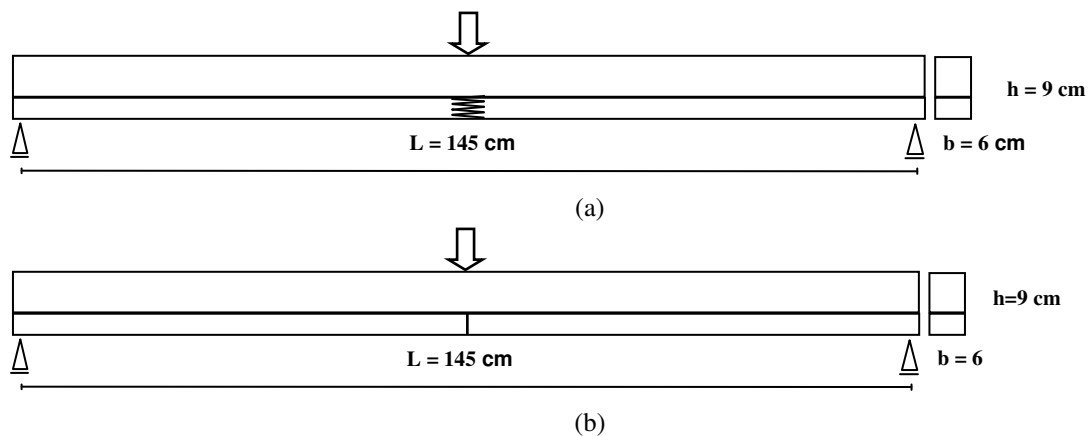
Tratamentos do ensaio de flexão destrutiva em vigas laminadas coladas solidarizadas entre peças componentes e lâminas com dentes horizontais (a) e verticais (b)
